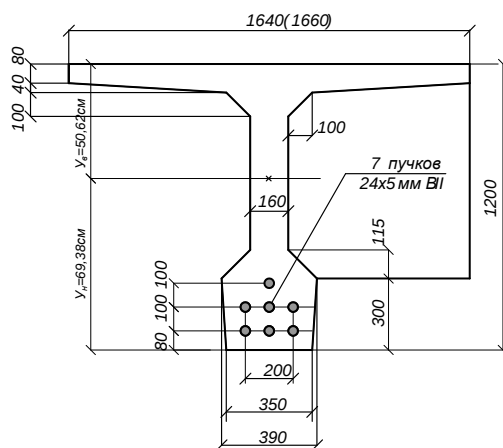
Поперечний переріз крайній балок прогонової будови довжиною 22,16 м
